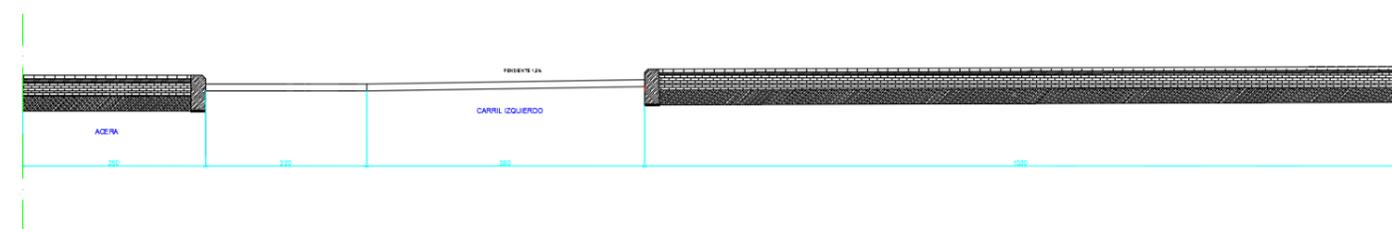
Sección 2 peatonalizada (Fuente: Elaboración propia)
